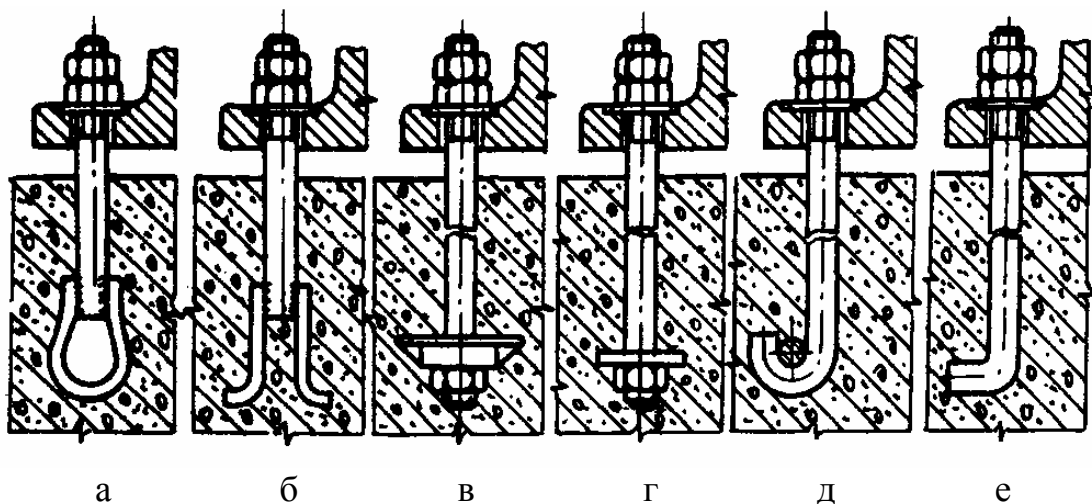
Глухі анкерні болти встановлювані до бетонування фундаменті
